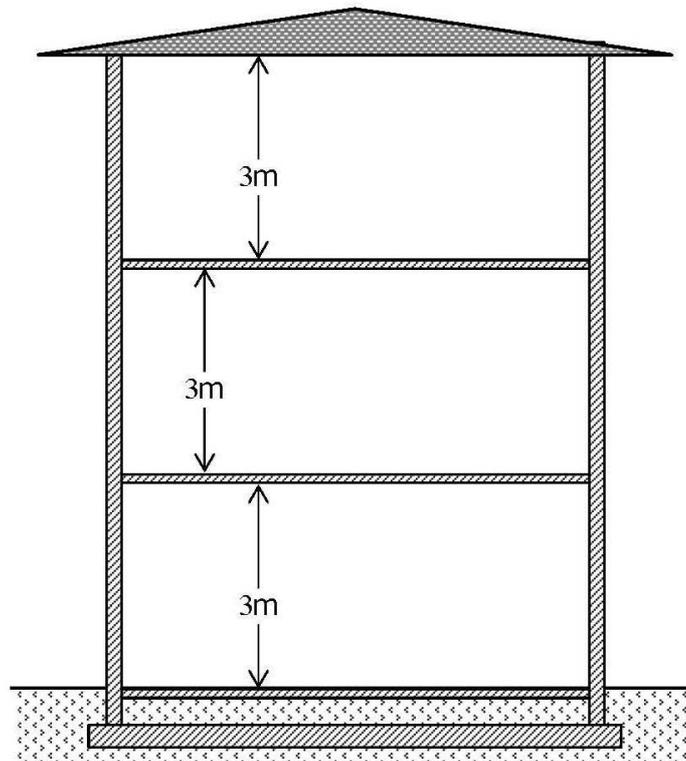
Exemple d'un bâtiment de type 2 : bâtiment d'habitation collectif R+2
